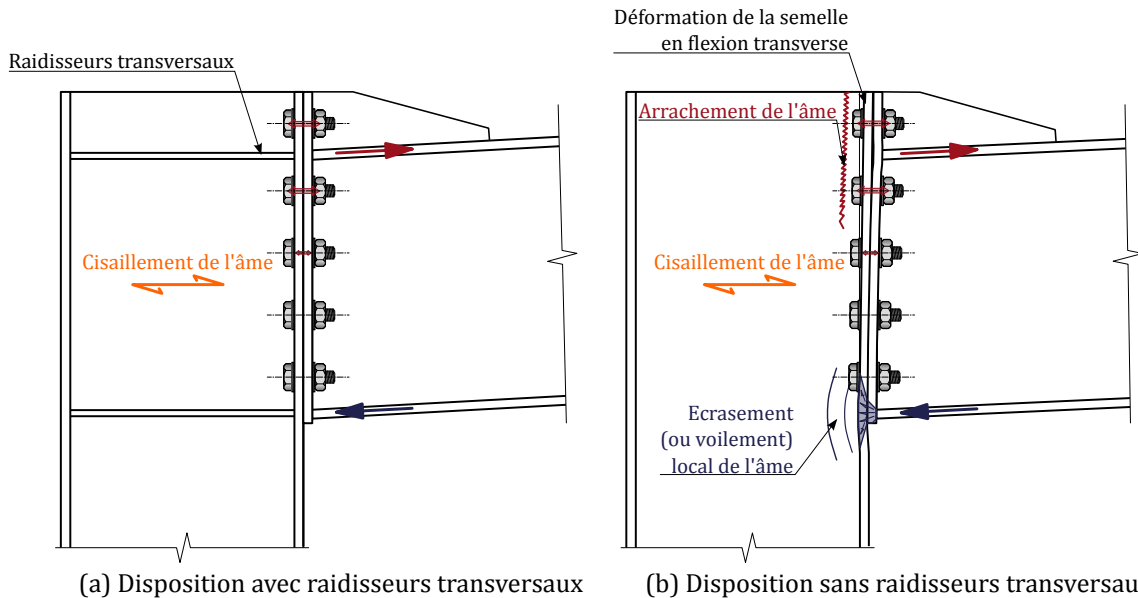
Fonctionnement de la continuité poutre-poteau par platine d'about
